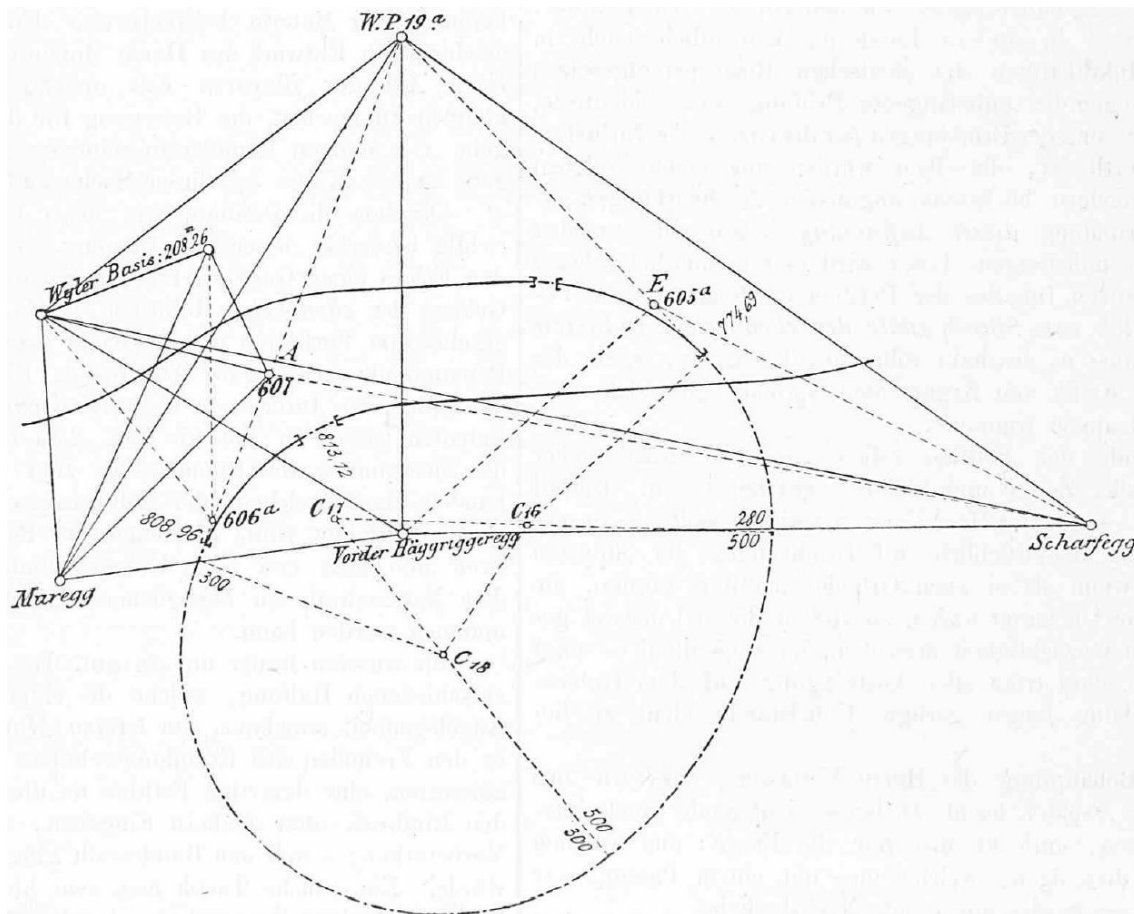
Pfaffensprung, Tunnelachse und Geometrie ([S.N.] 1881c, S. 98)
